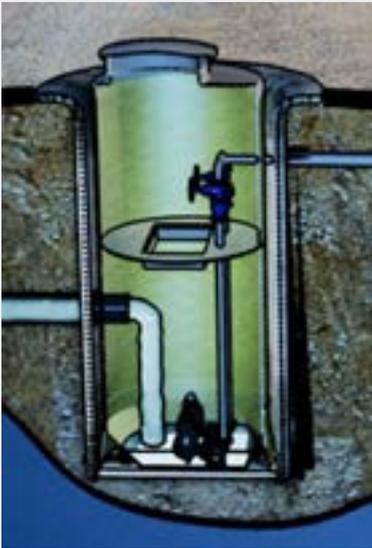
Eine neue vorgefertigte Einschub-Pumpstation für eine vorhandene Betonstruktur
